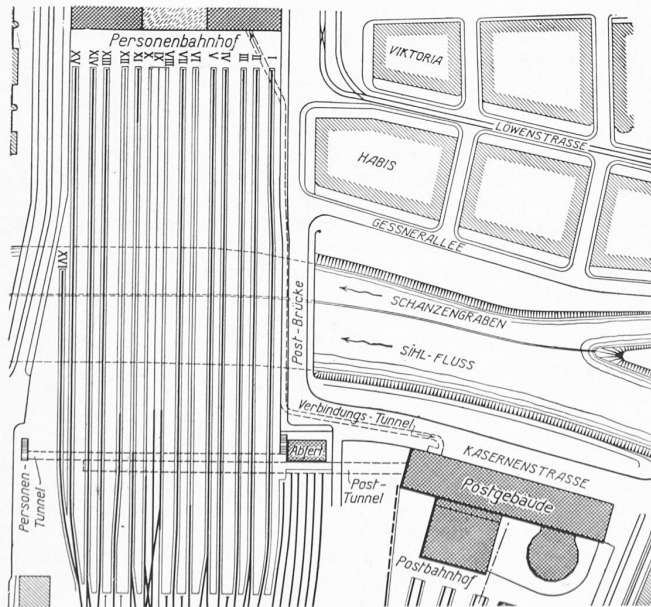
Lageplan 1:4000 Zürich Hauptbahnhof Sihlpost
